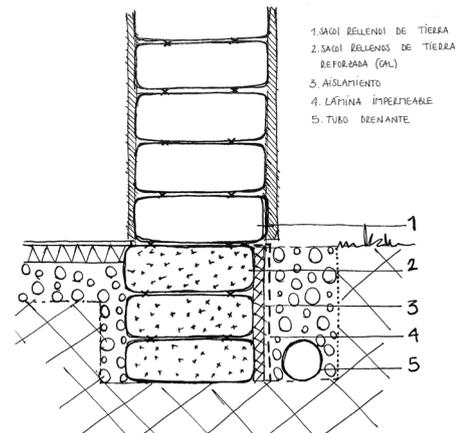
Detalle de cimentación con zapata perimetral de sacos de tierra reforzada. Elaboración propia
